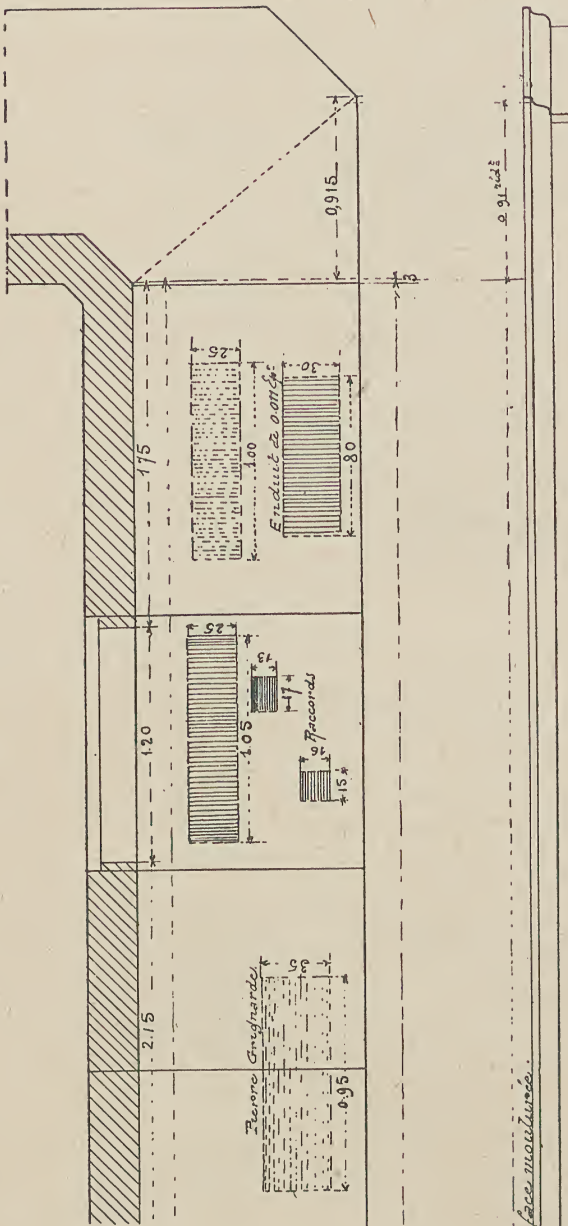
et 53. — Plan, coupe et élévation du balcon de l'étage d'attique. — Ravalement et restauration en ciment métallique.
